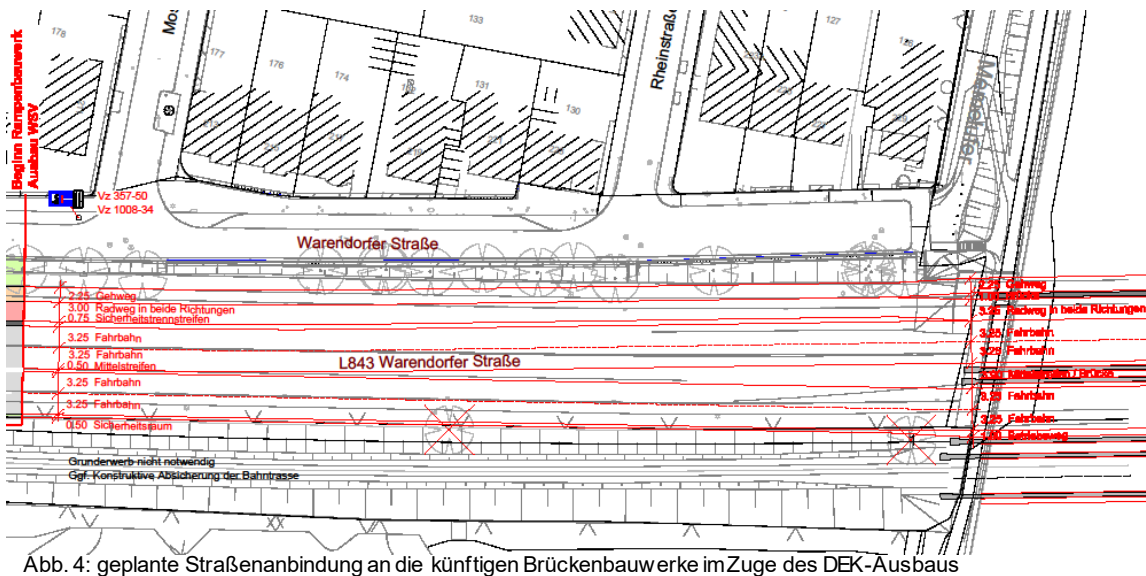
geplante Straßenanbindung an die künftigen Brückenbauwerke im Zuge des DEK-Ausbau
